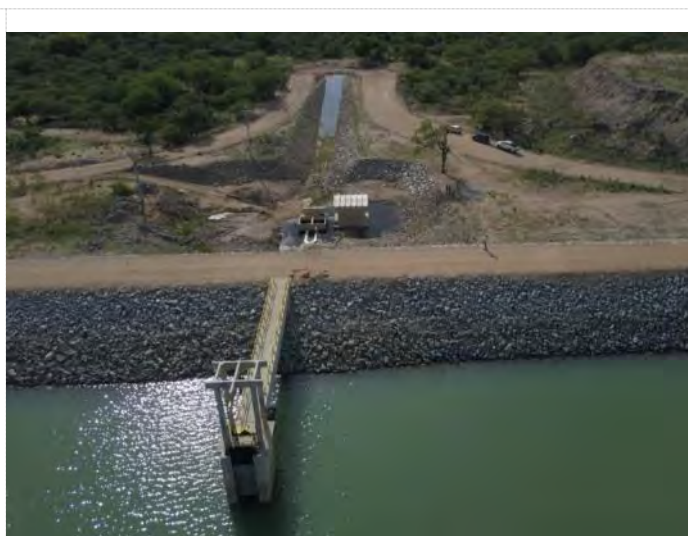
Barragem Salgueiro – Vista aérea da TUD
